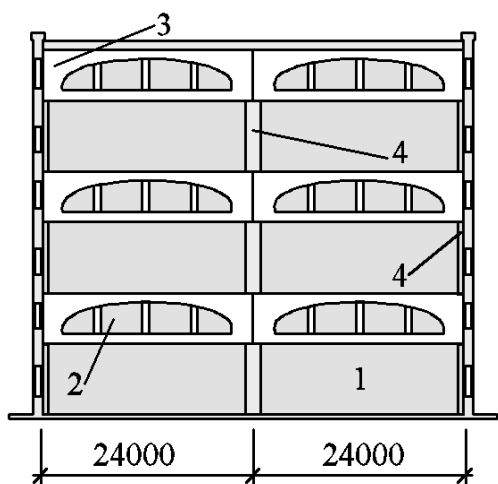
Промислова будівля з міжфермовими поверхами:
